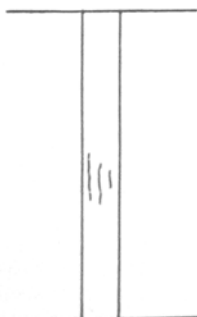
Fissuras verticais no pilar indicando insuficiência de estribos. (Fonte: THOMAZ)
